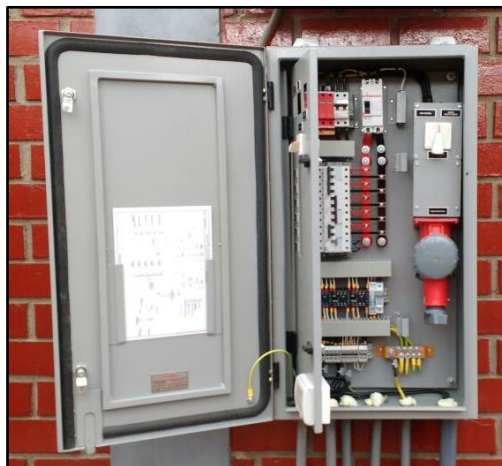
Tablero Eléctrico – Vista Interior.
